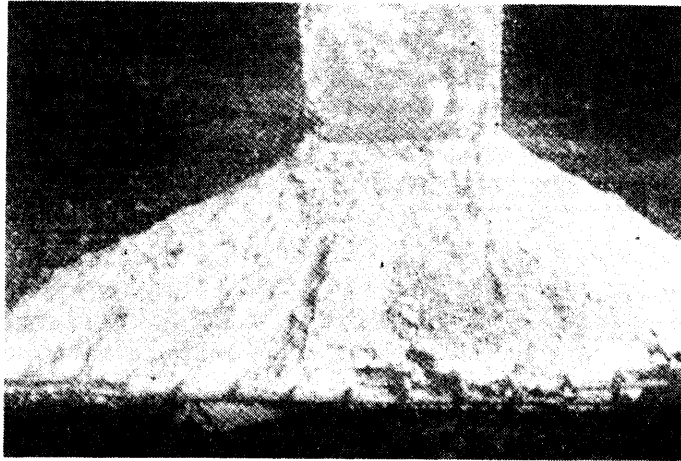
Fondasi beton bertulang setelah penggalian. (Tes oleh F.E. Richart.)
